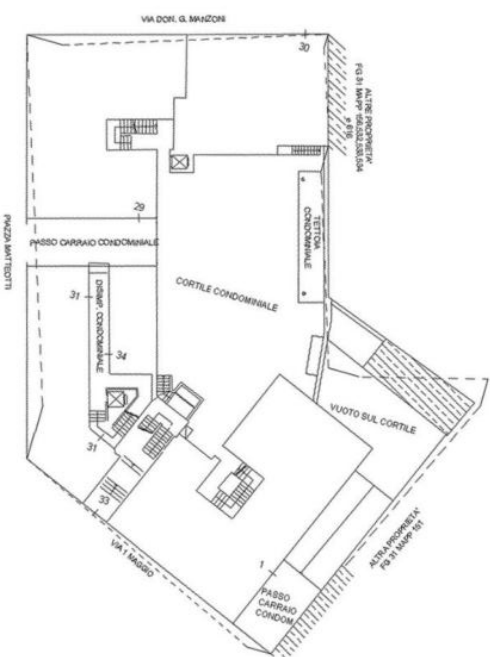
Estratto dal catasto –stralcio dell'elaborato planimetrico relativo al piano terra dello stabile
